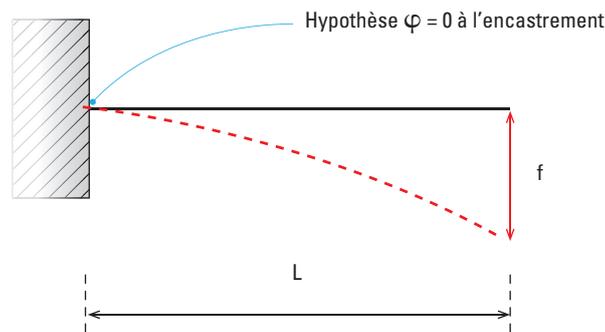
Flèche d'une poutre/dalle parfaitement encastrée à l'appui
